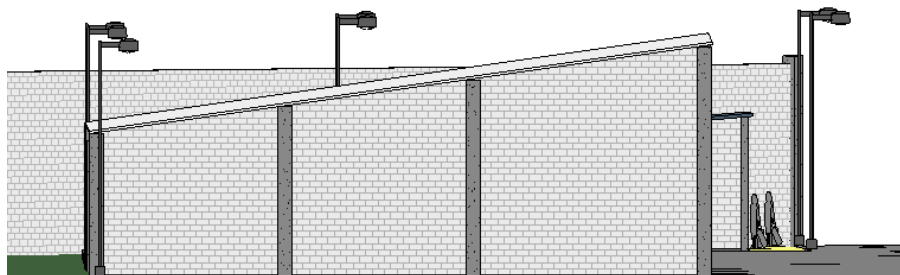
Fachada lateral izquierda donde también puede apreciarse el dormitorio de vigilantes y el muro perimetral al fondo, sin escala.
